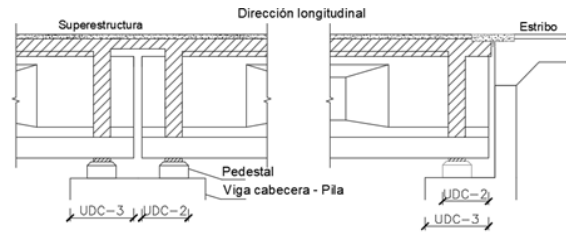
Longitud de apoyo disponible para la superestructura, en Pila y Estribos.
